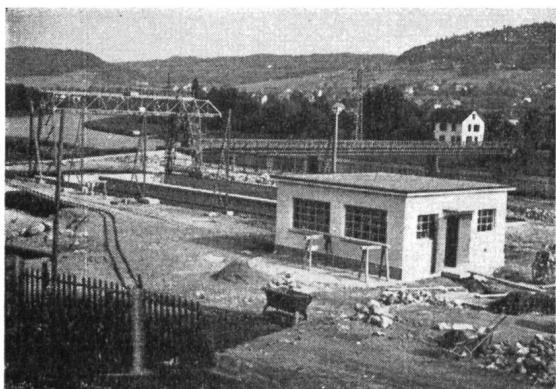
Abwasserpumpwerk mit den beiden Klärbecken und dem Portalkran.
